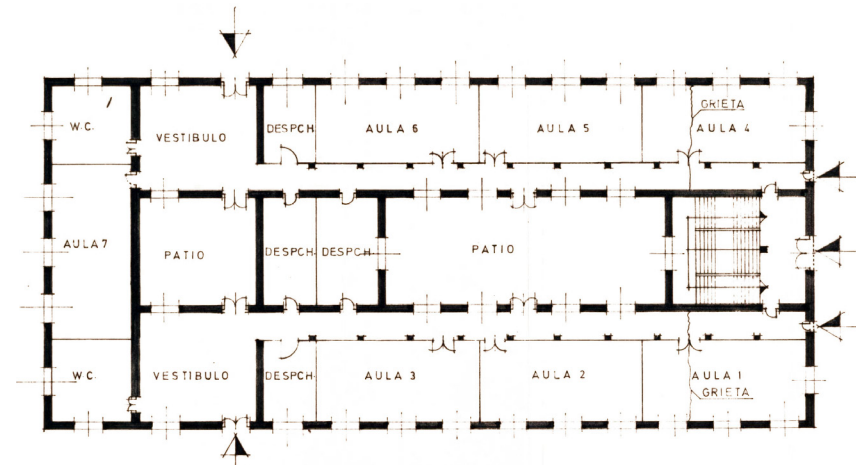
, Planta Baja. Proyecto 1970, Alejandro Vila Ruiz
